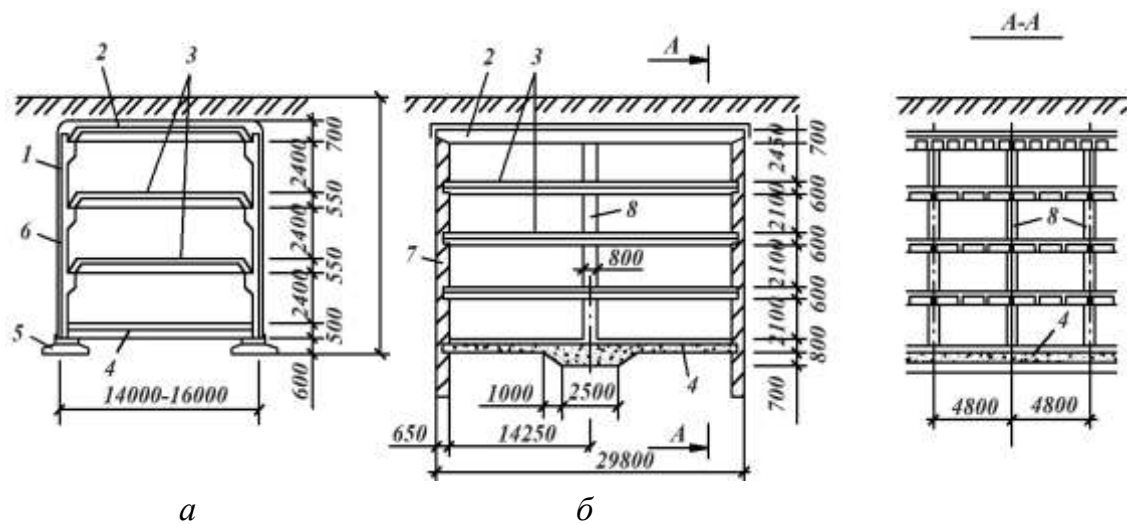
Конструкції підземних гаражів: *а* – однопрогінні; *б* – двопрогінні; 1 – стіновий блок; 2 – верхнє покриття; 3 – між'ярусне покриття; 4 – лоток; 5 – фундамент; 6 – гідроізоляція; 7 – траншейна стіна; 8 – колони
